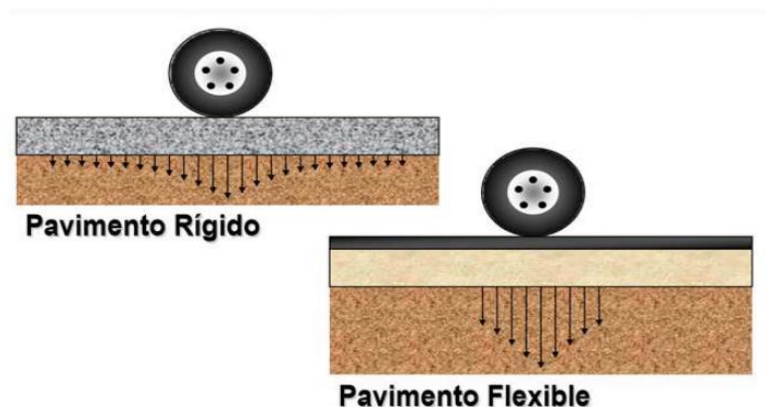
Distribución de peso en un pavimento flexible y pavimento rígido.
